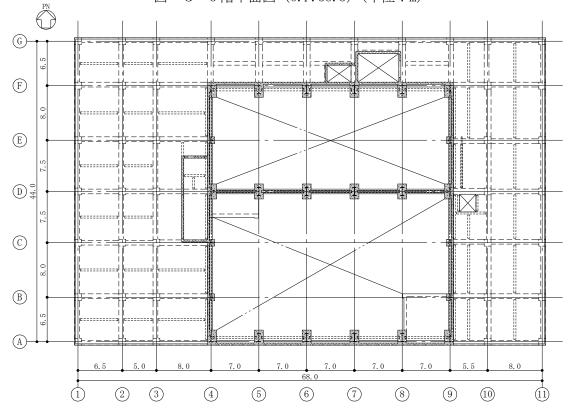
屋根平面図 (その1) (0.P.44.3) (単位:m)
